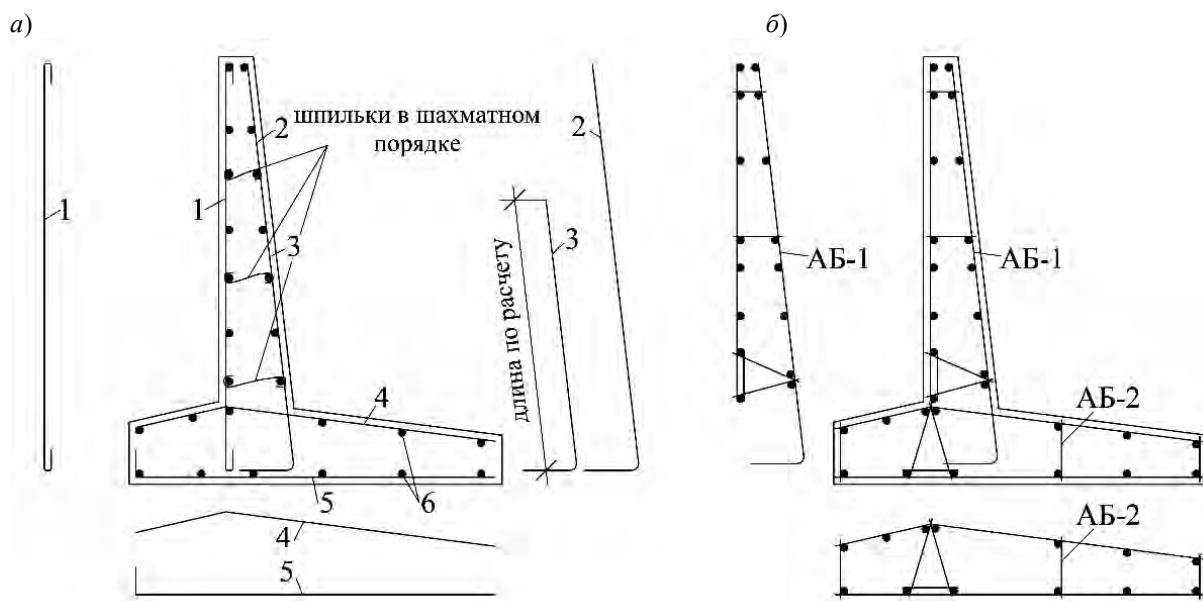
Схема армирования уголковой подпорной стенки отдельными стержнями (а) и армоблоками (б)
